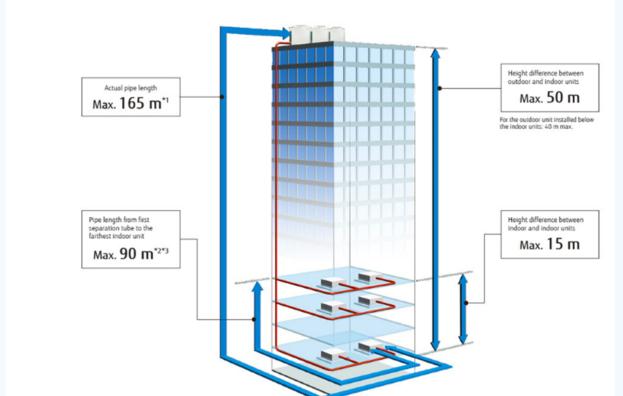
Installation de la tuyauterie VRF Flexibilité
